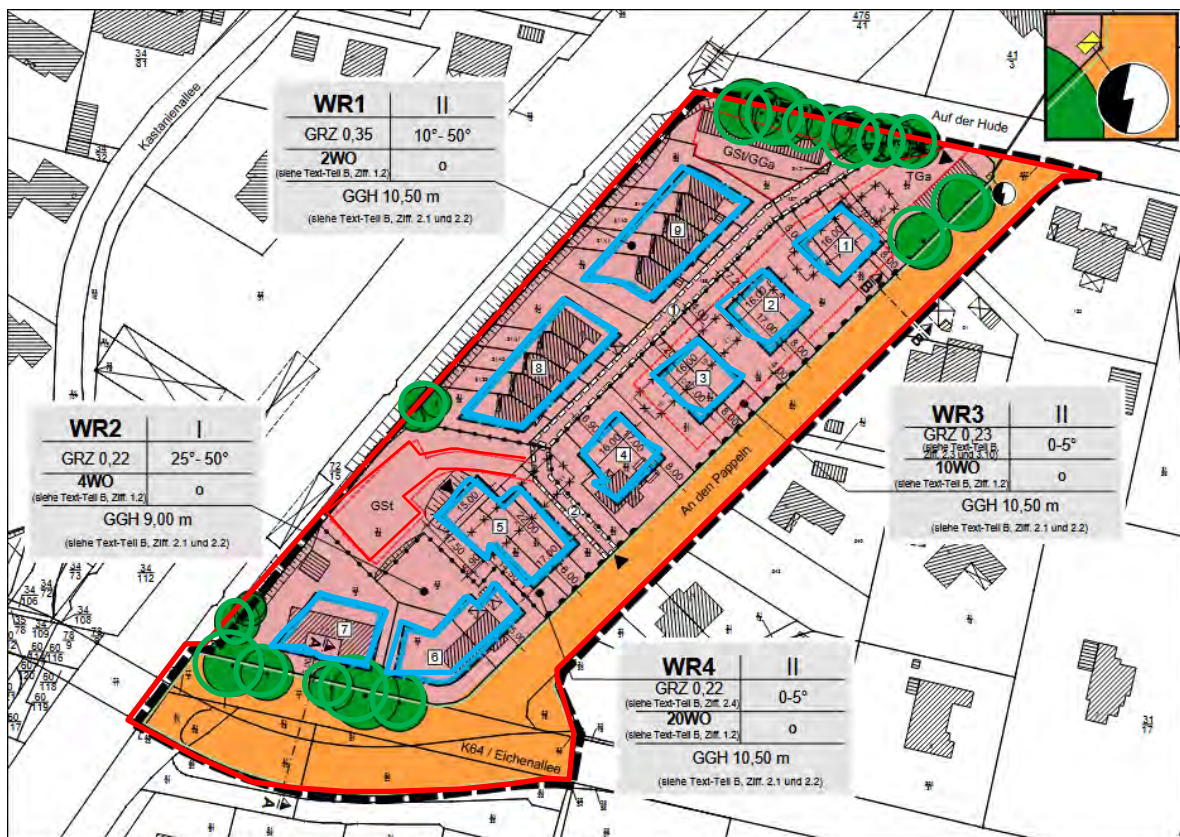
Ausschnitt aus der B-Plan-Zeichnung zum B-Plan Nr.25 (Büro BSK, März 2023)
